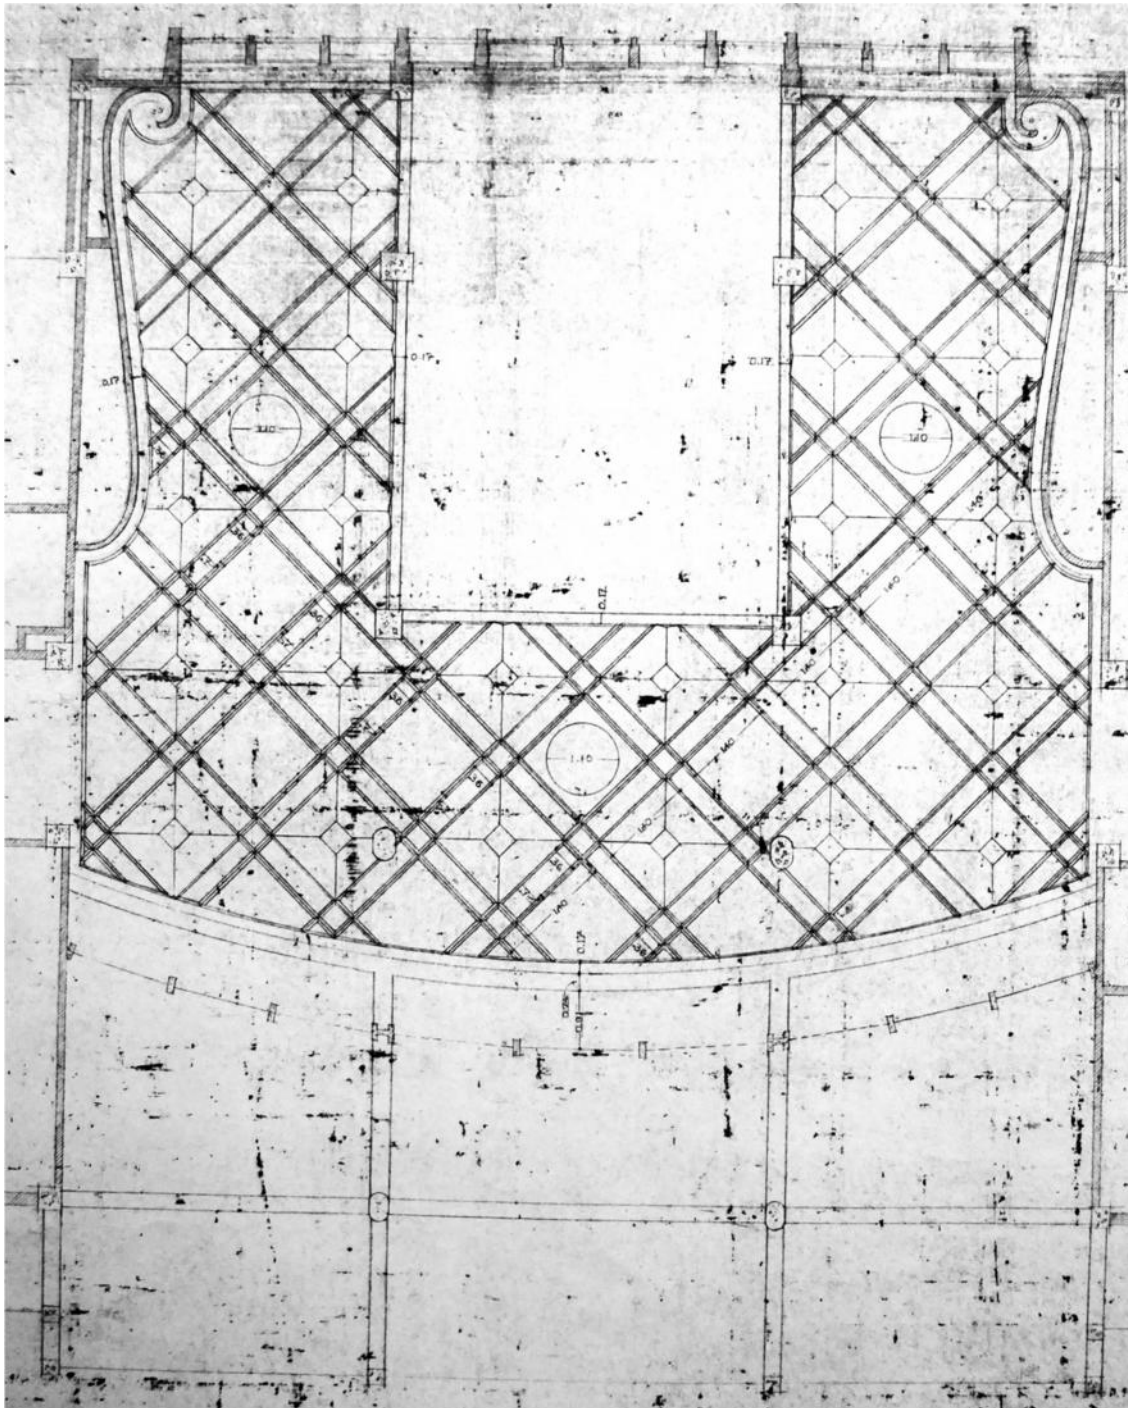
Mayo 30 de 1944. Planta de cielo raso hall
